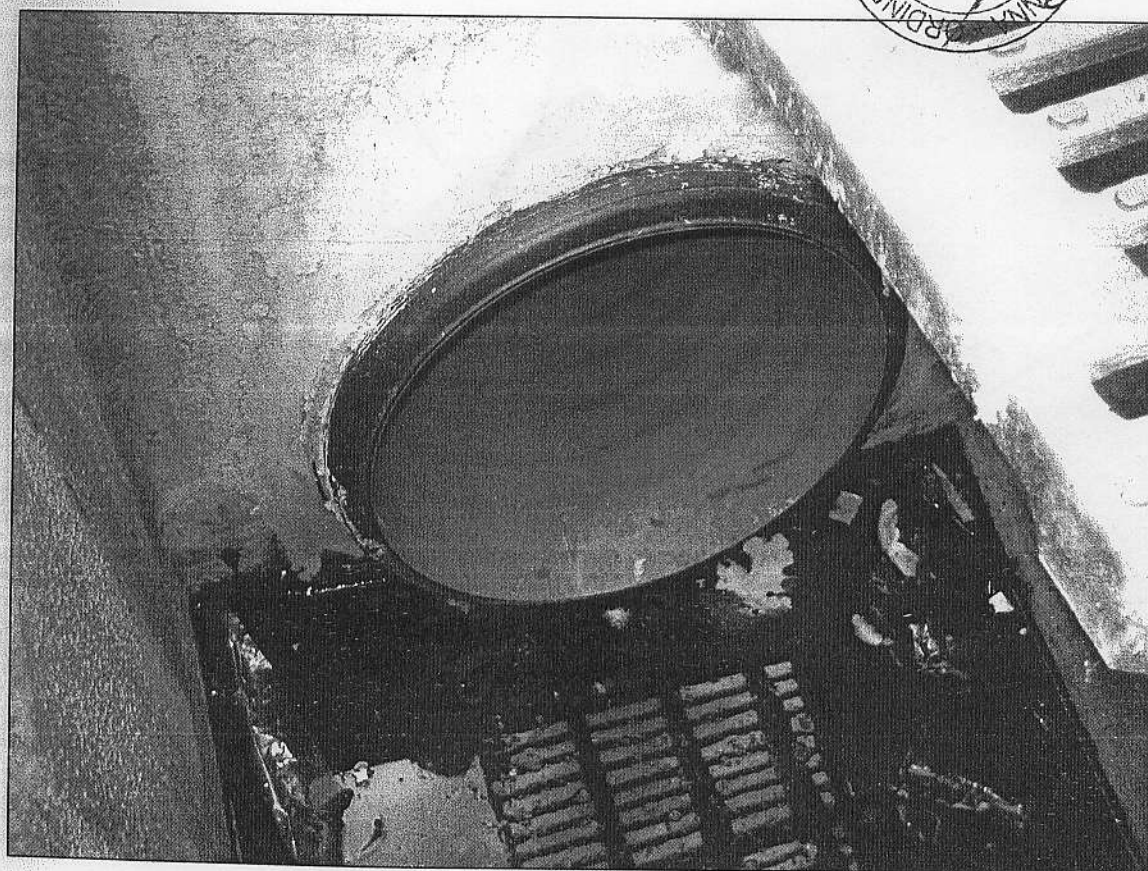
Particolare dell'interno della caditoia di cui alla foto n. 7
